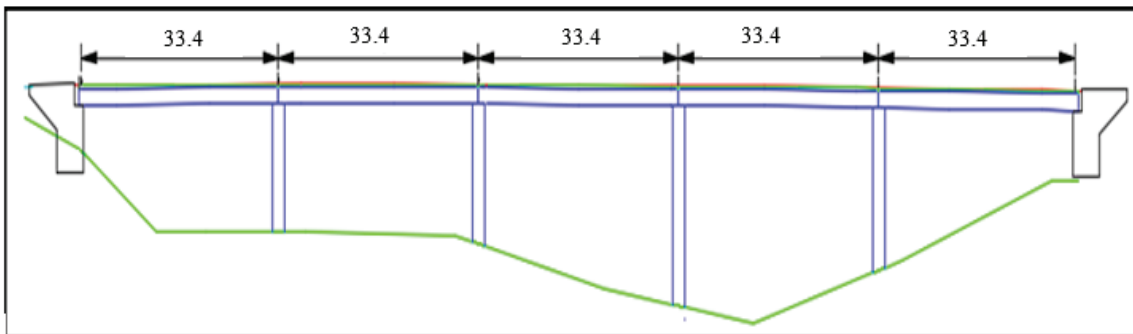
La coupe longitudinale de la variante Ponts à poutres préfabriquées précontraintes par post-tension.
